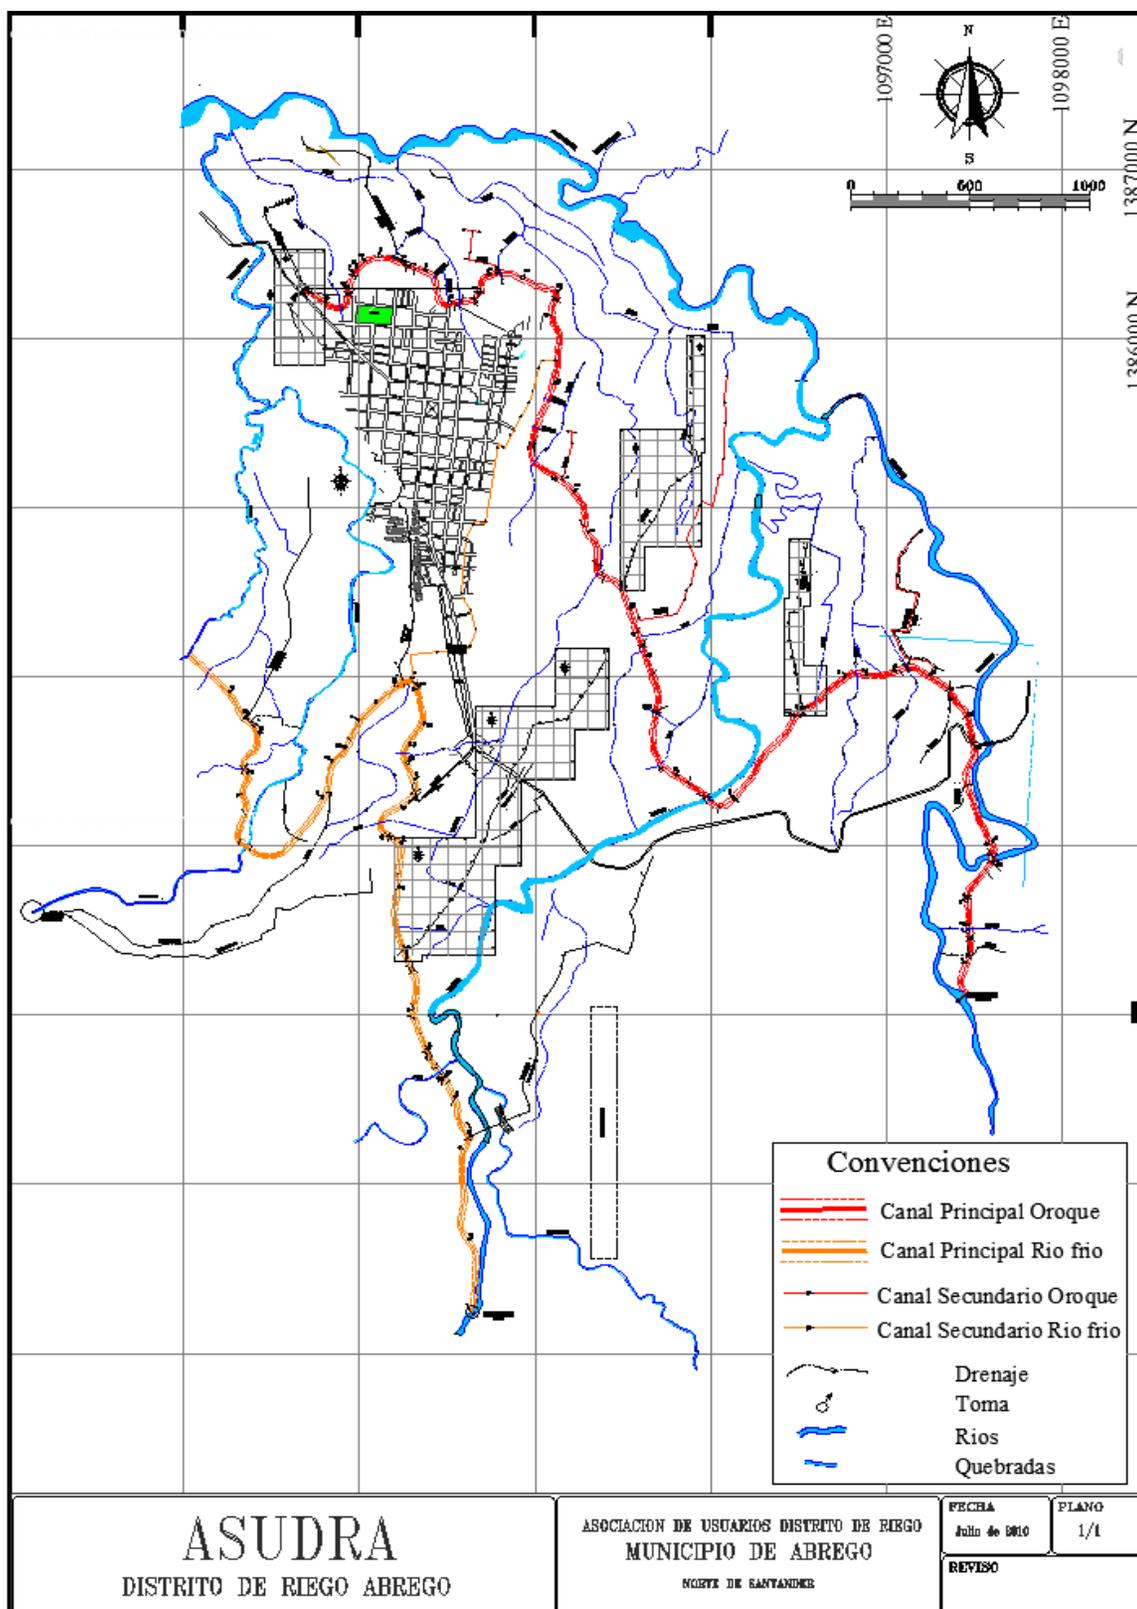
Plano en planta de los canales del distrito de riego ASUDRA. Fuente: Administración ASUDRA 2017, modificado por Autores.
